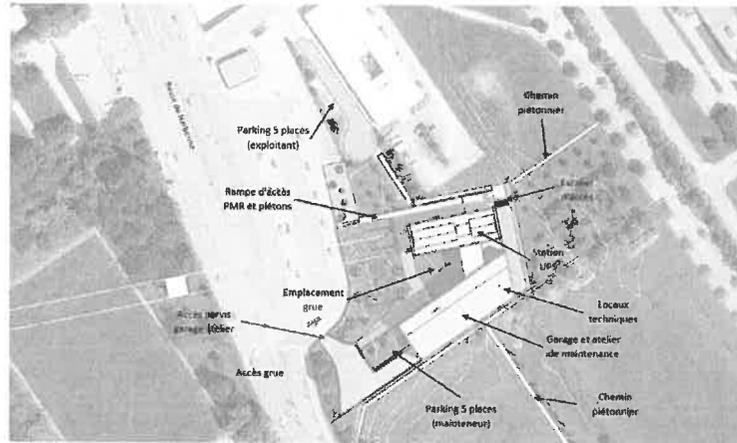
Détails de la station UPS (source : Groupement POMA, 2018)
